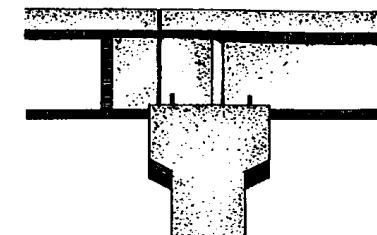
Неправильное опирание балок покрытия на колонну из-за смещения колонны в плане
